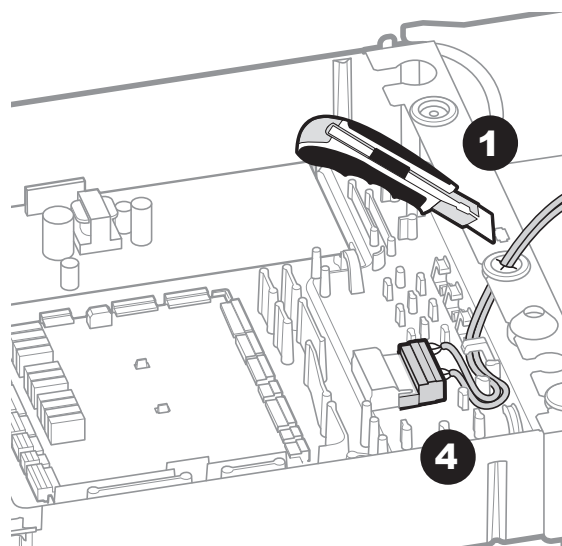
Raccordement sécurité plancher chauffant au bornier (module hydraulique)
